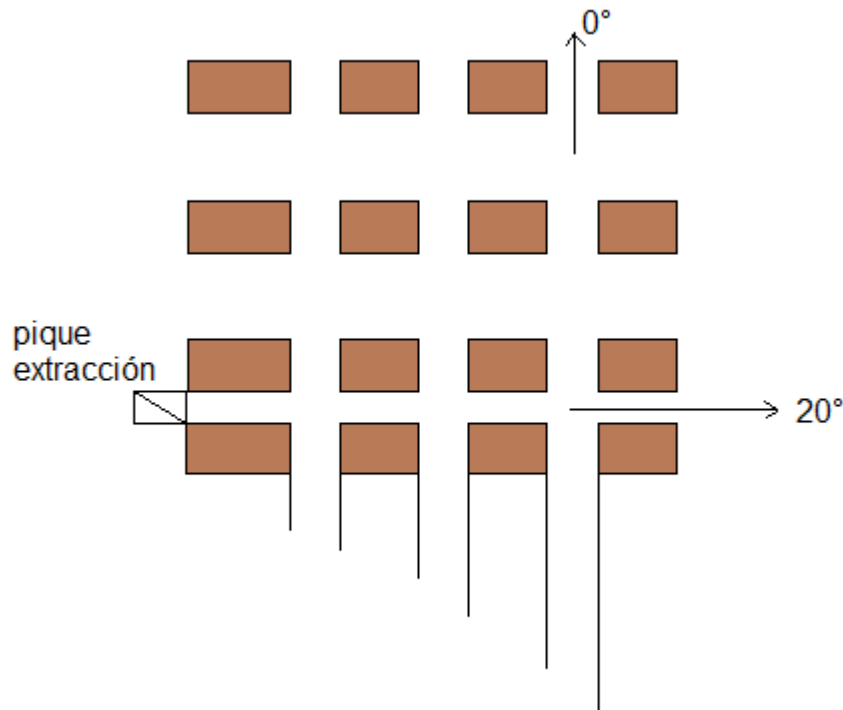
Vista Planta Esquema Explotación Caserones y Pilares
